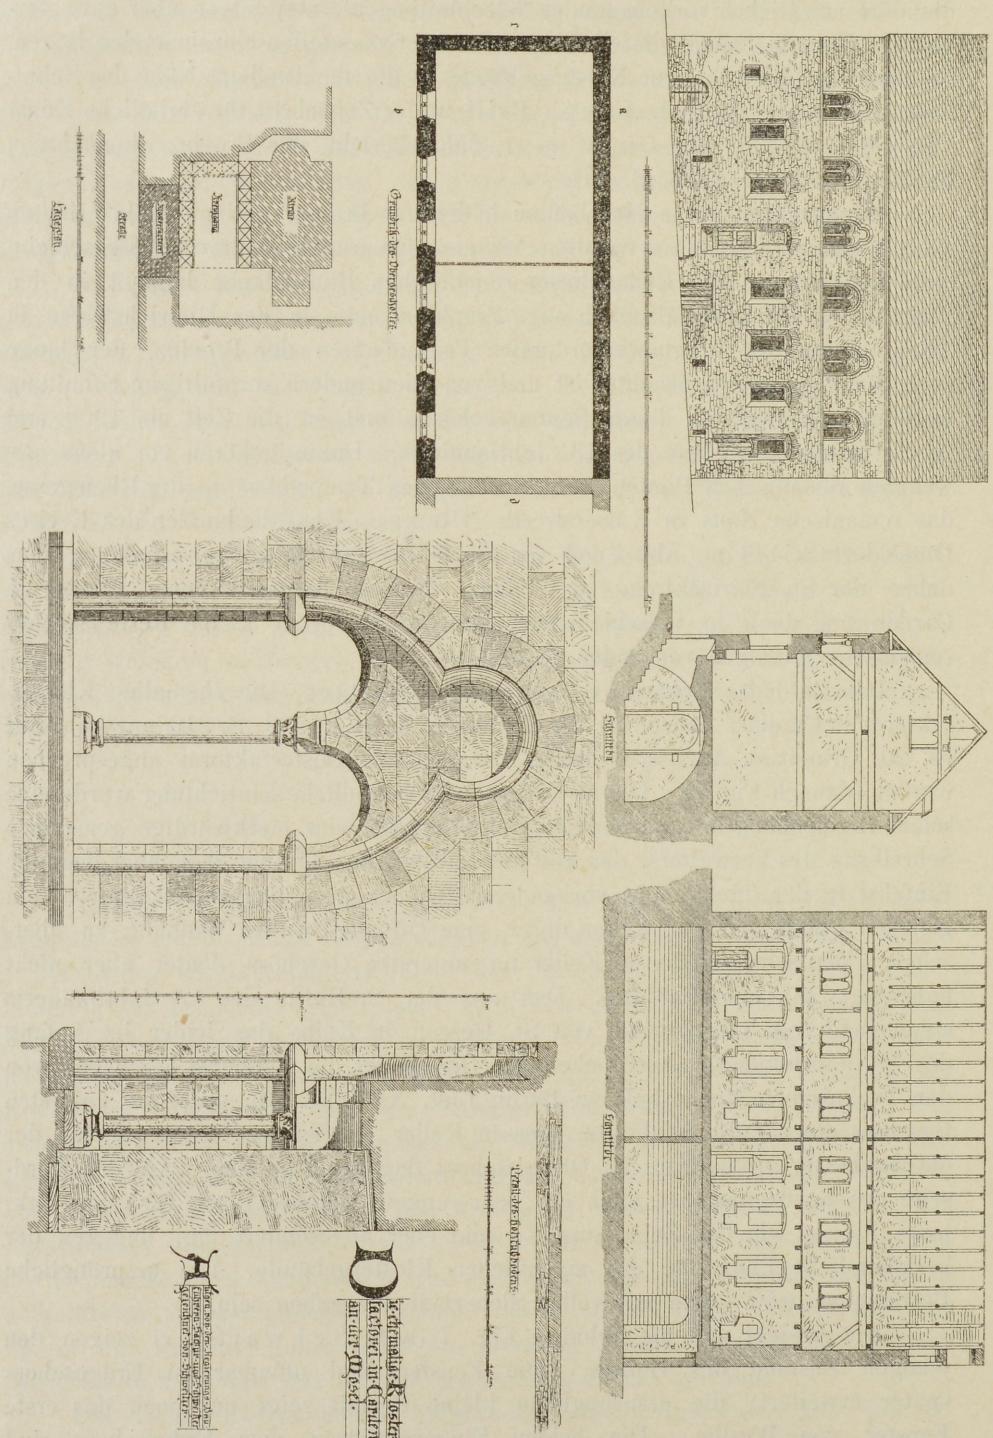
Carden, Romanisches Klostergebäude. Grundriss, Aufriss, Schnitt und Details.
